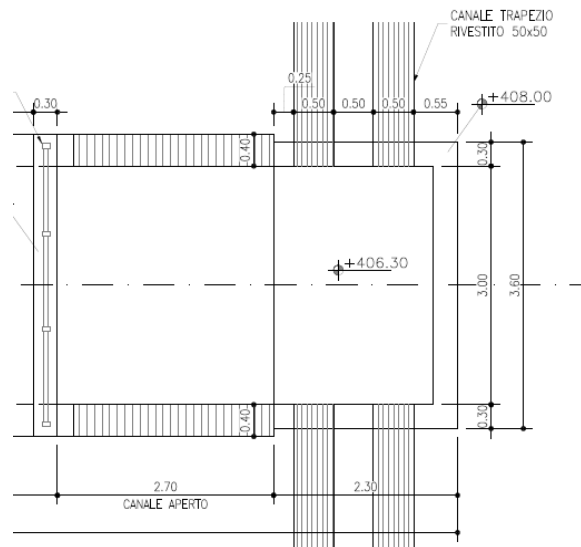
Manufatto d'imbocco - Sezione longitudinale
